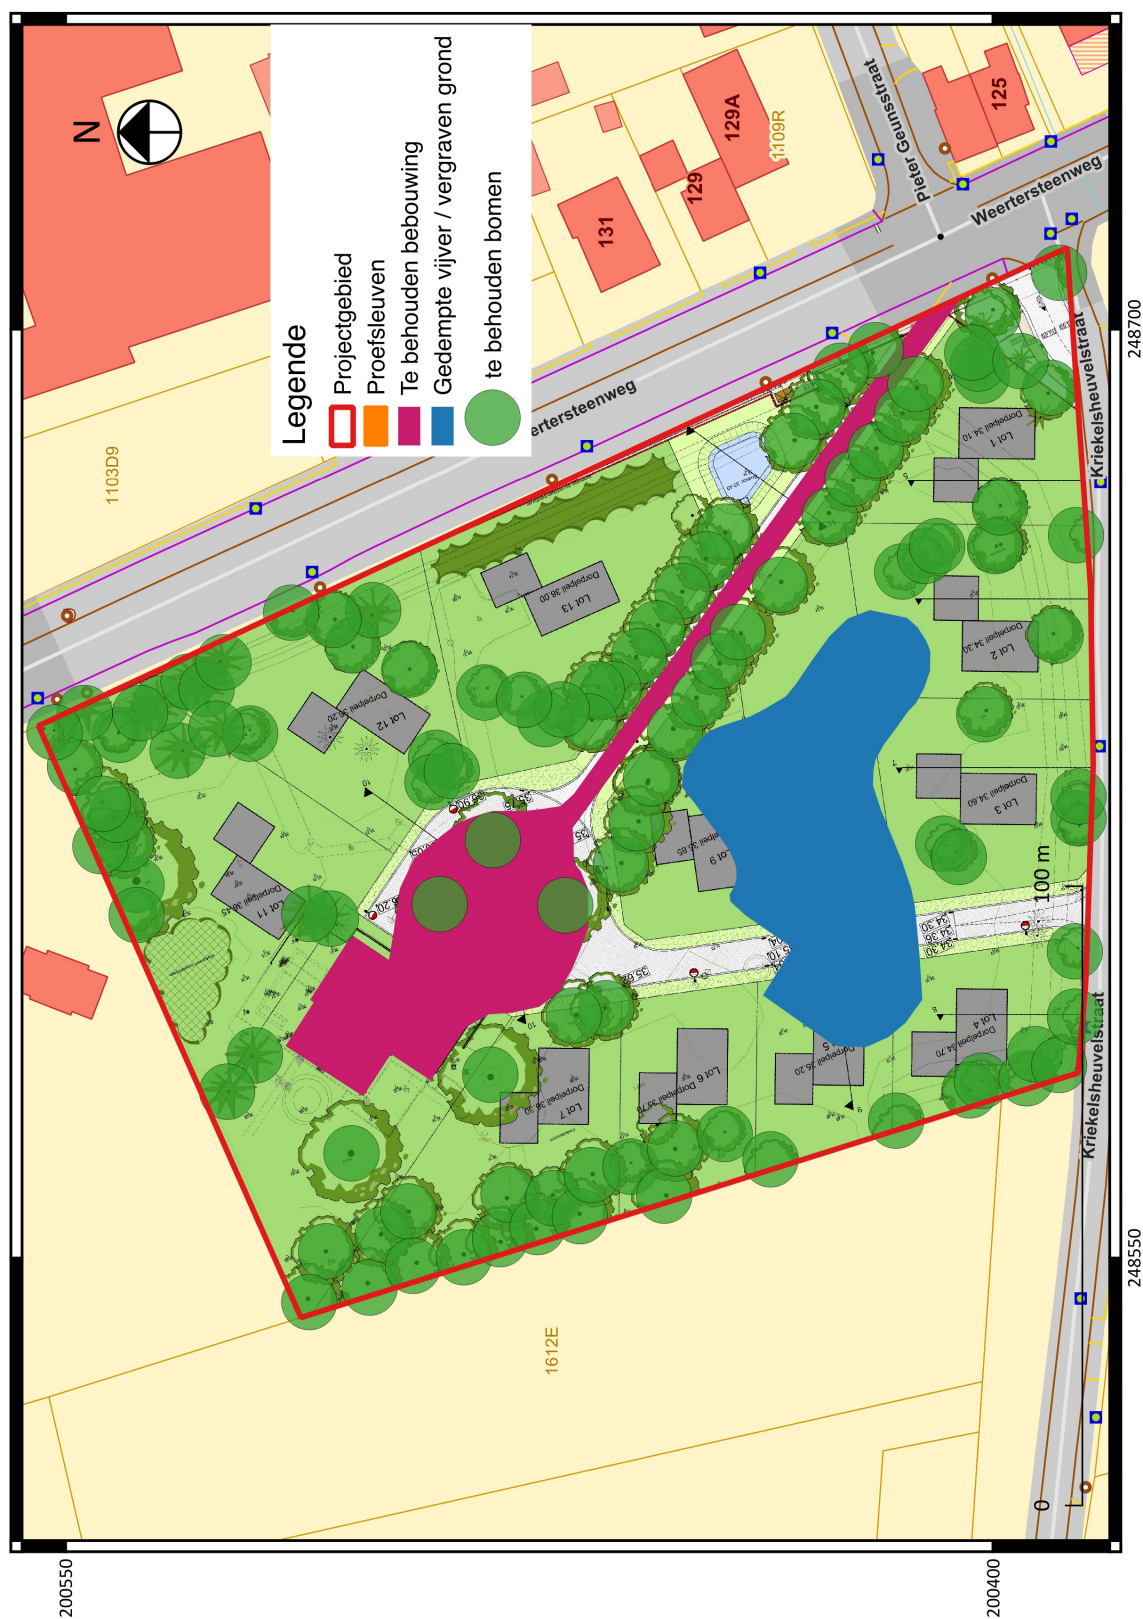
Inplantingsplan met aanduiding van de te behouden bomen, de vergraven zone en de te behouden bebouwing / infrastructuur.
